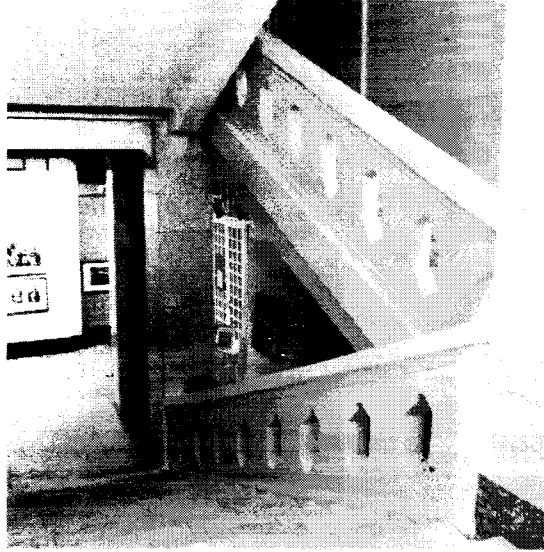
Парадная лестница. Вид с лестничной площадки между первым и вторым этажом
